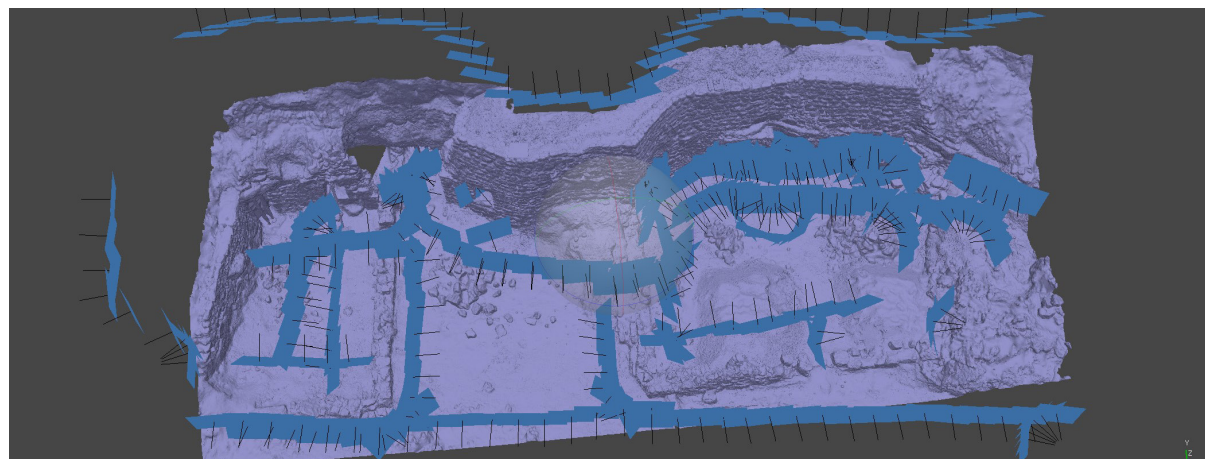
Levantamiento de la fachada en obras con los datos de Mayo. Modelo sólido y posicionamiento de cámaras. Fuente: Elaboración propia
